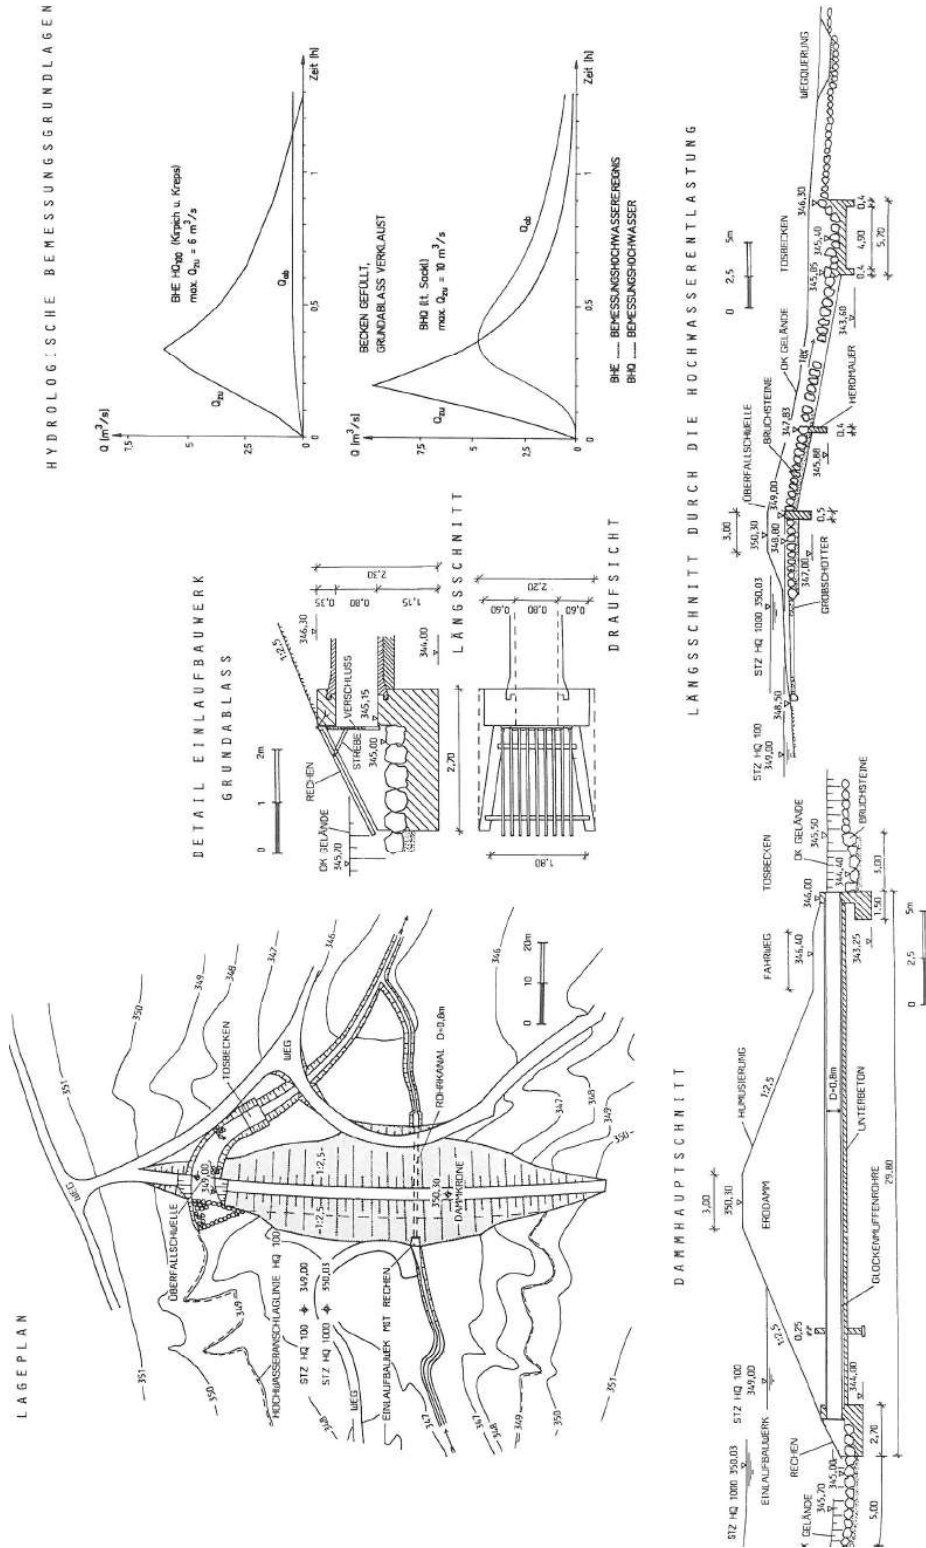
Lageplan und Schnitte, HRB Lindenbach
